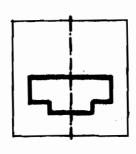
TIPOLOGIA DEL LOTE Y DE LA VIVIENDA
